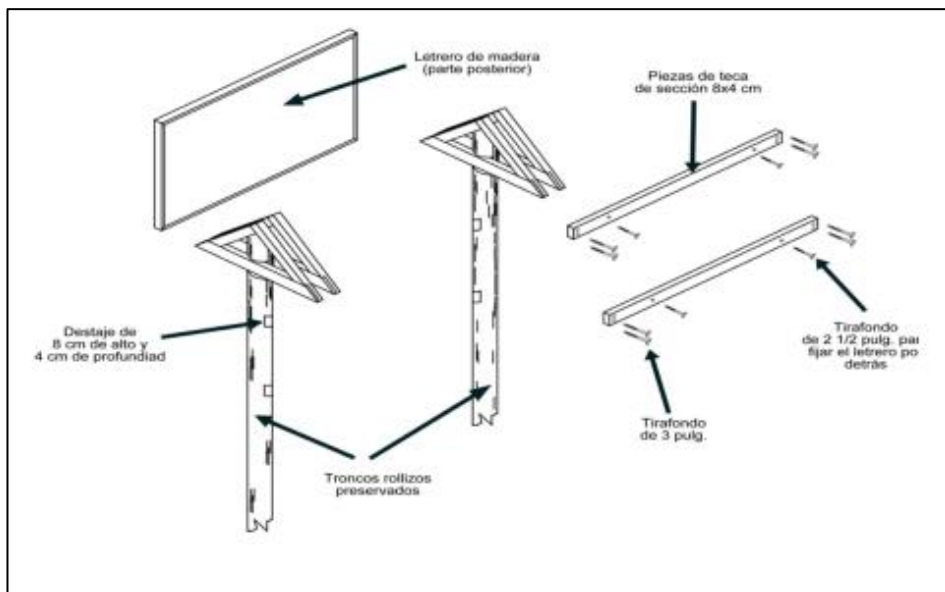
Detalle de la instalación del letrero de madera en el armazón
